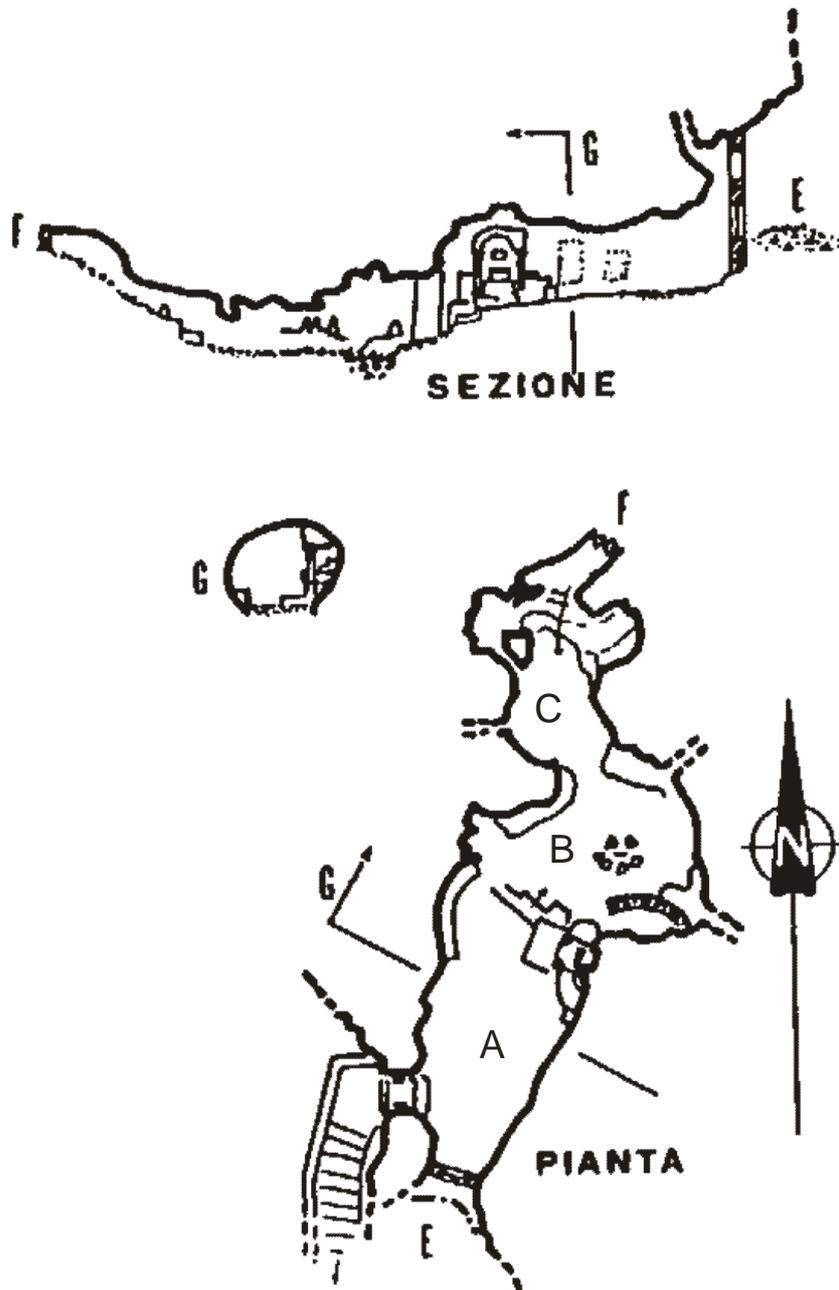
S. Michele al monte Tancia, planimetria e sezione (fonte: Felici – Cappa 1987, p. 15, modificata dall'autore)
